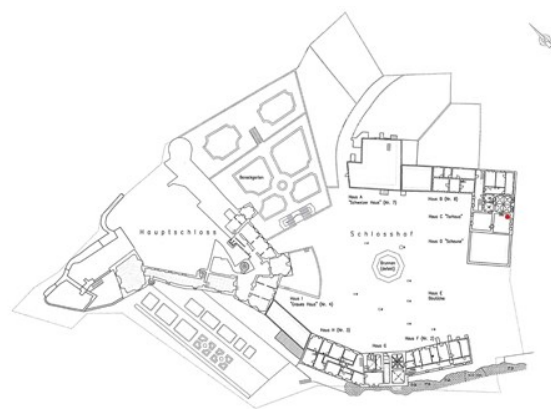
Grundriss von Schloss Lauenstein. Fundstelle des Münzschatzes rot markiert. Maßstab 1:500.
